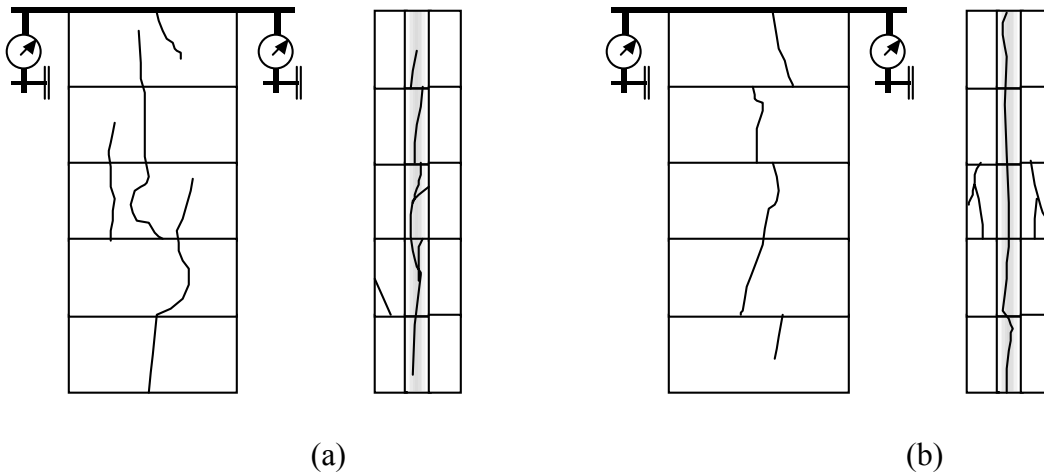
Mapa da fissuração em P1 e 2 de [1x5] – face sul e oeste
